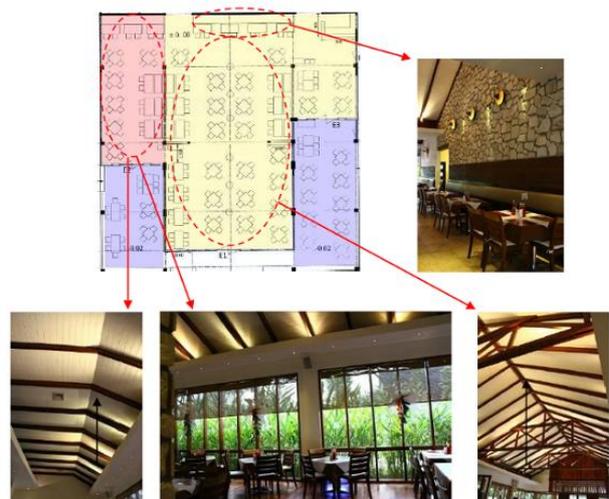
Perencanaan Ruang Lantai Boncafe Graha Famili
